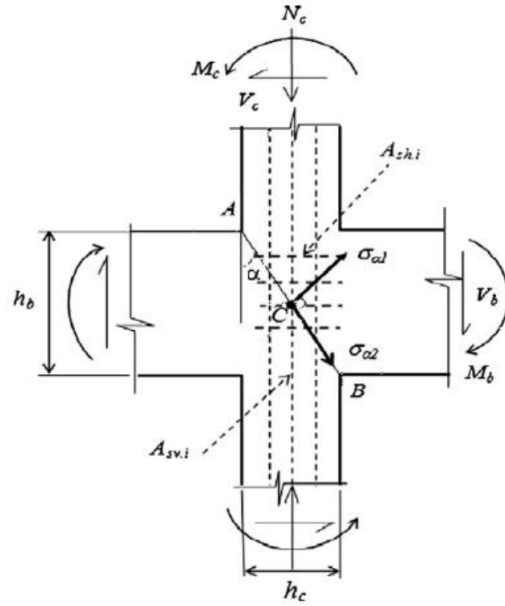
Mecanismo de falla en unión viga-columna [33]
